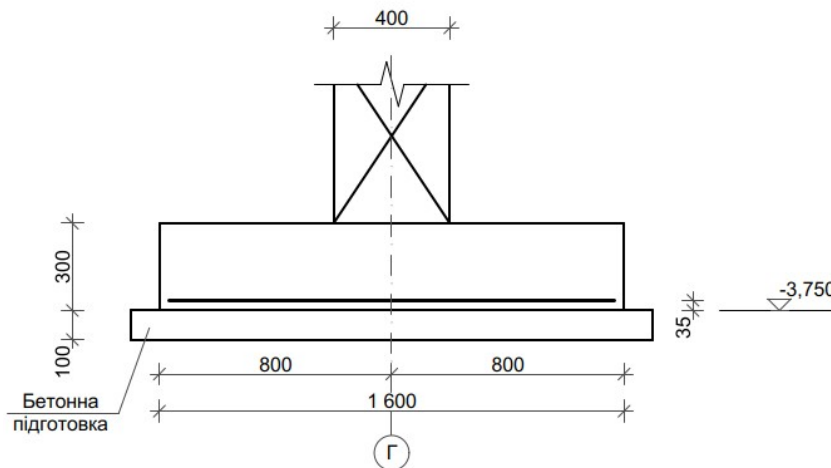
Конструювання монолітного стрічкового фундаменту
